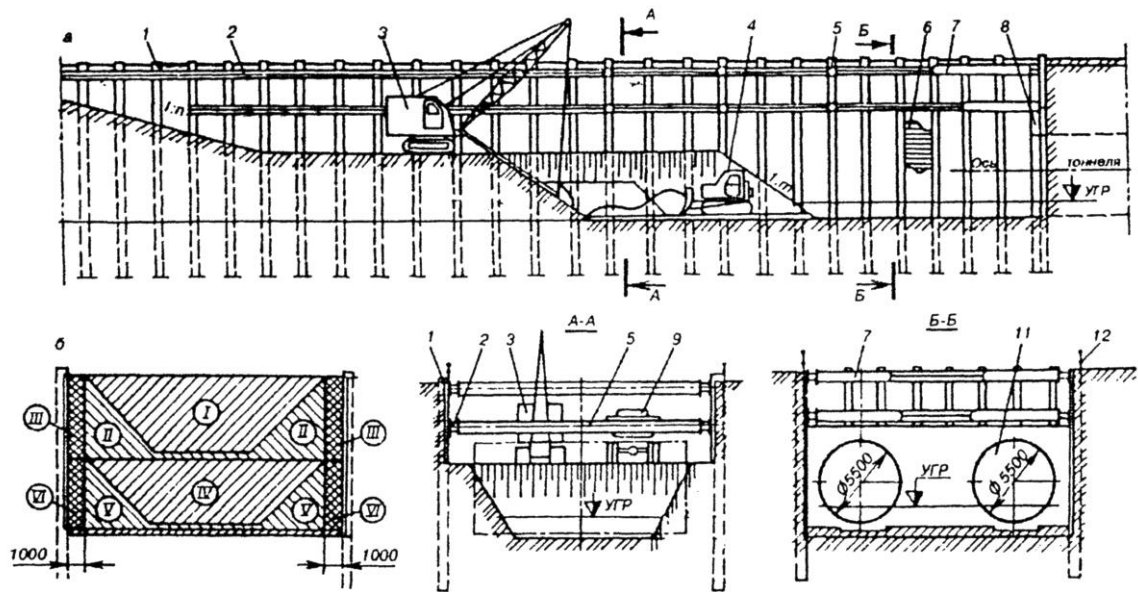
Схема розробки ґрунту при свайно-розпирному кріпленні котловану(а) та черговість розробки котловану (б):
